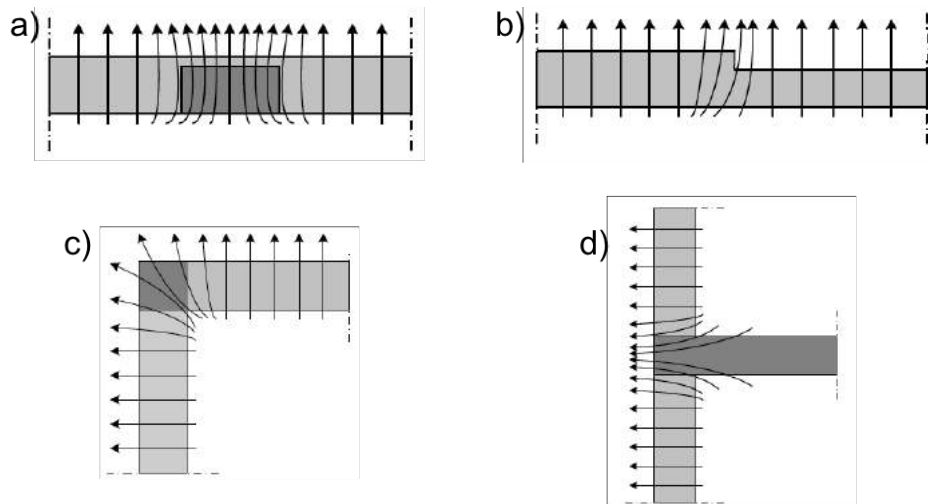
Pontes térmicas: a) devido à transição entre diferentes materiais; b) devido a alterações de espessura; c) devido a um pilar num cunhal; d) devido à ligação da laje com a fachada [43].
